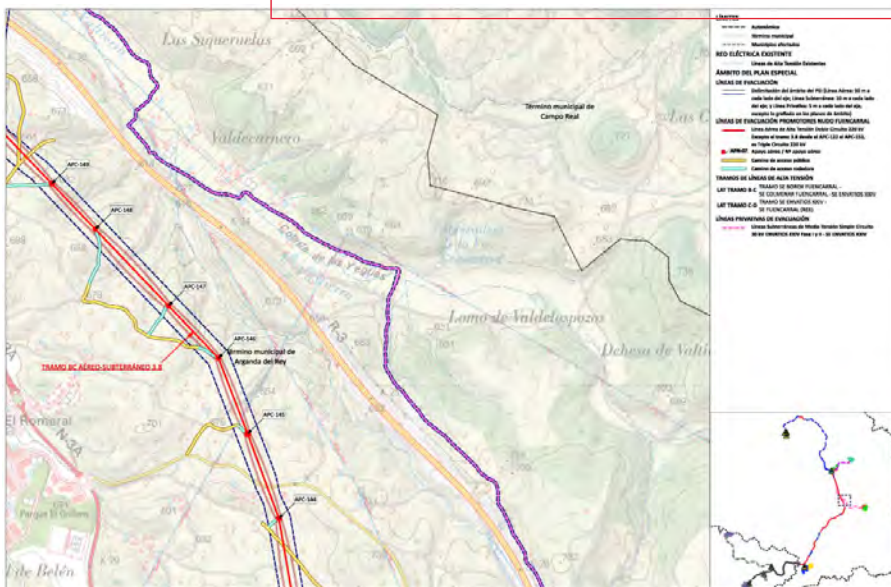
Plano de Ordenación O2.4.4. Planta por tramos. Instalaciones Envaios XXIV
